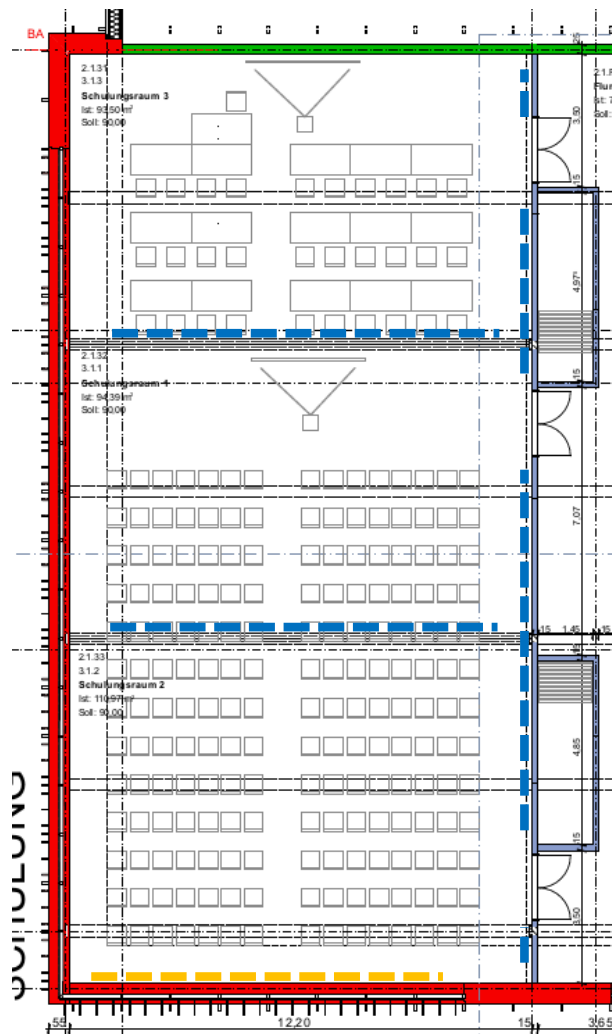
Grundriss Schulungsräume 1 bis 3 mit Bestuhlung (1fach geteilt) und Wandabsorbieren (blau gestrichelt) bzw. Vorhänge (orange gestrichelt)
